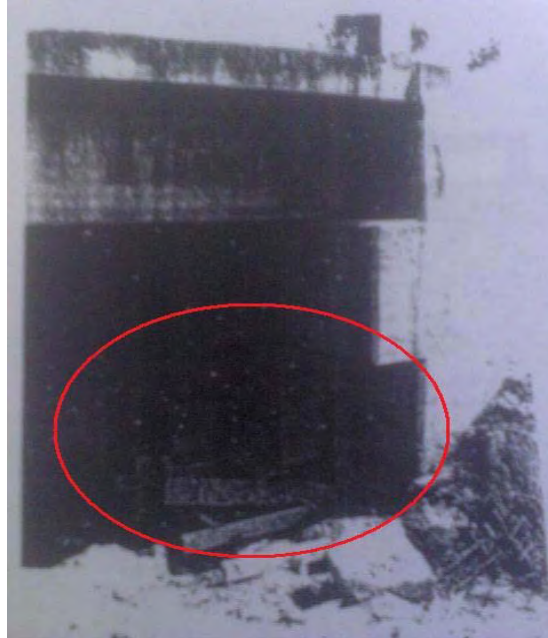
Puente en Ban Kathun – Phibun, el terraplén de acceso falló; provocando daño severo en el estribo de apoyo de la superestructura
